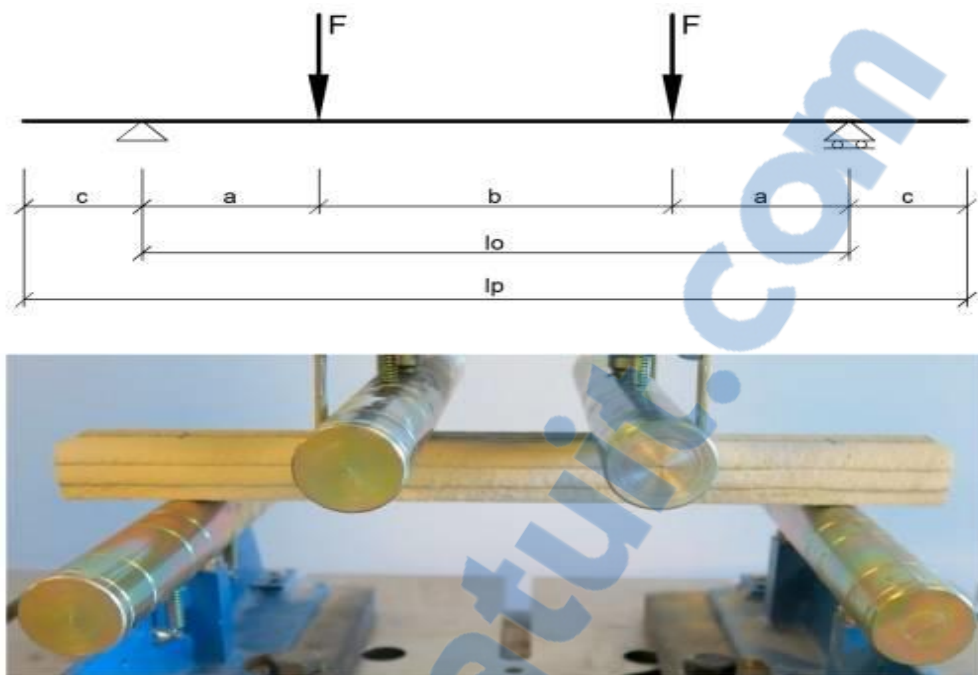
Test de flexion sur poutre en béton imprimée en 3D avec armature de câble [11]
